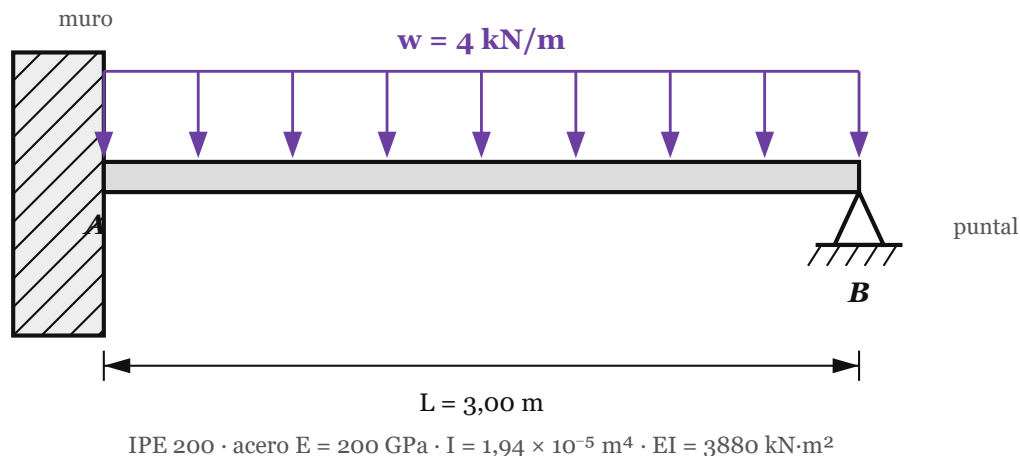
Modelo analítico: viga empotrada en A, apoyada en B (voladizo apuntalado) con carga uniformemente distribuida.
